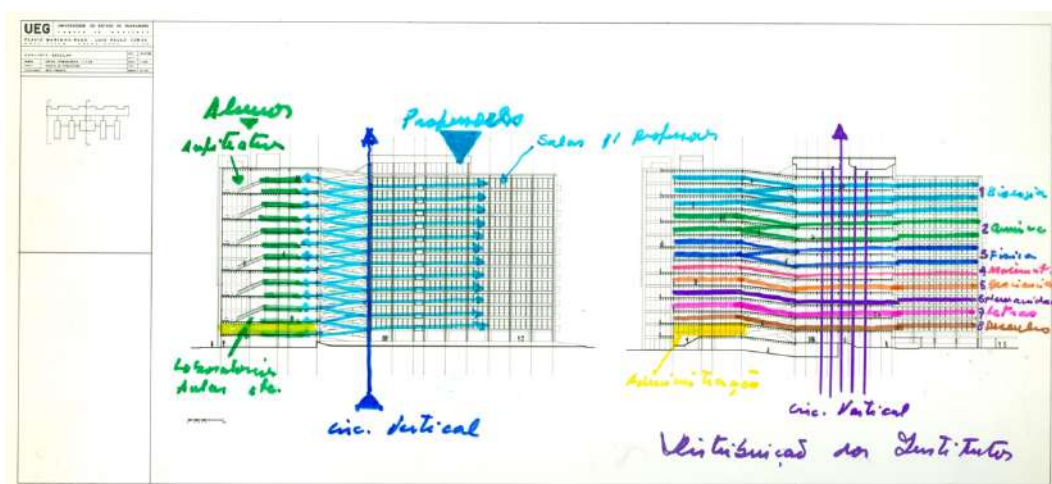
Pavilhão João Lyra Filho - Seção 1.1 e 2.2.
